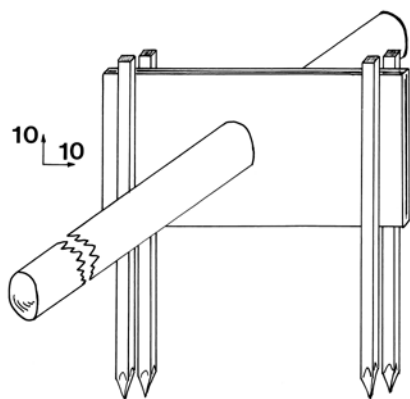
Tuyau encastré dans un panneau de bois; dimensions en cm
